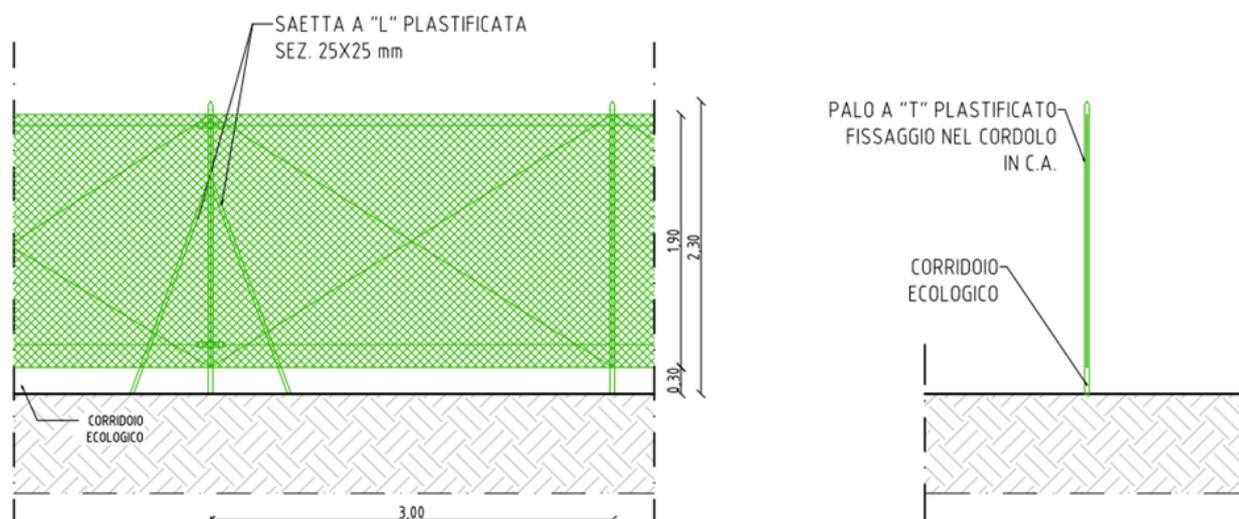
Dettaglio recinzione - Prospetto e sezione
